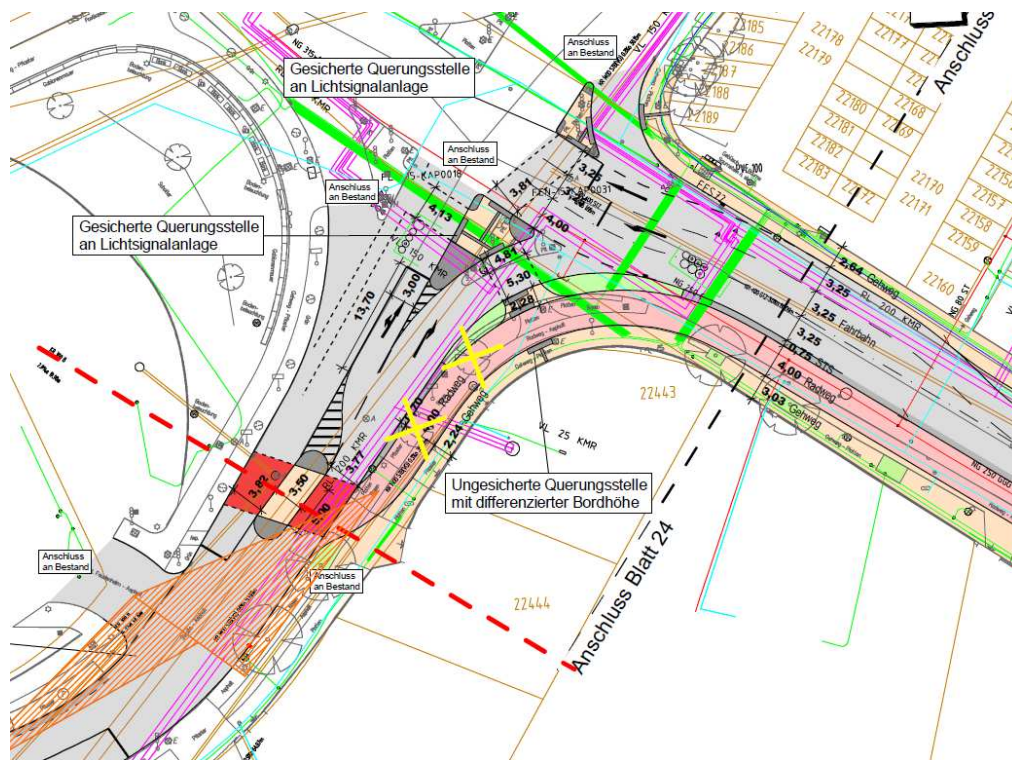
Betroffene Bäume (gelbe Kreuze) in der Odenwaldstraße Einmündung Ilvesheimer Straße, Führung westlich davon als Fahrradstraße, separate Radwegführung im Kreuzungsbereich
